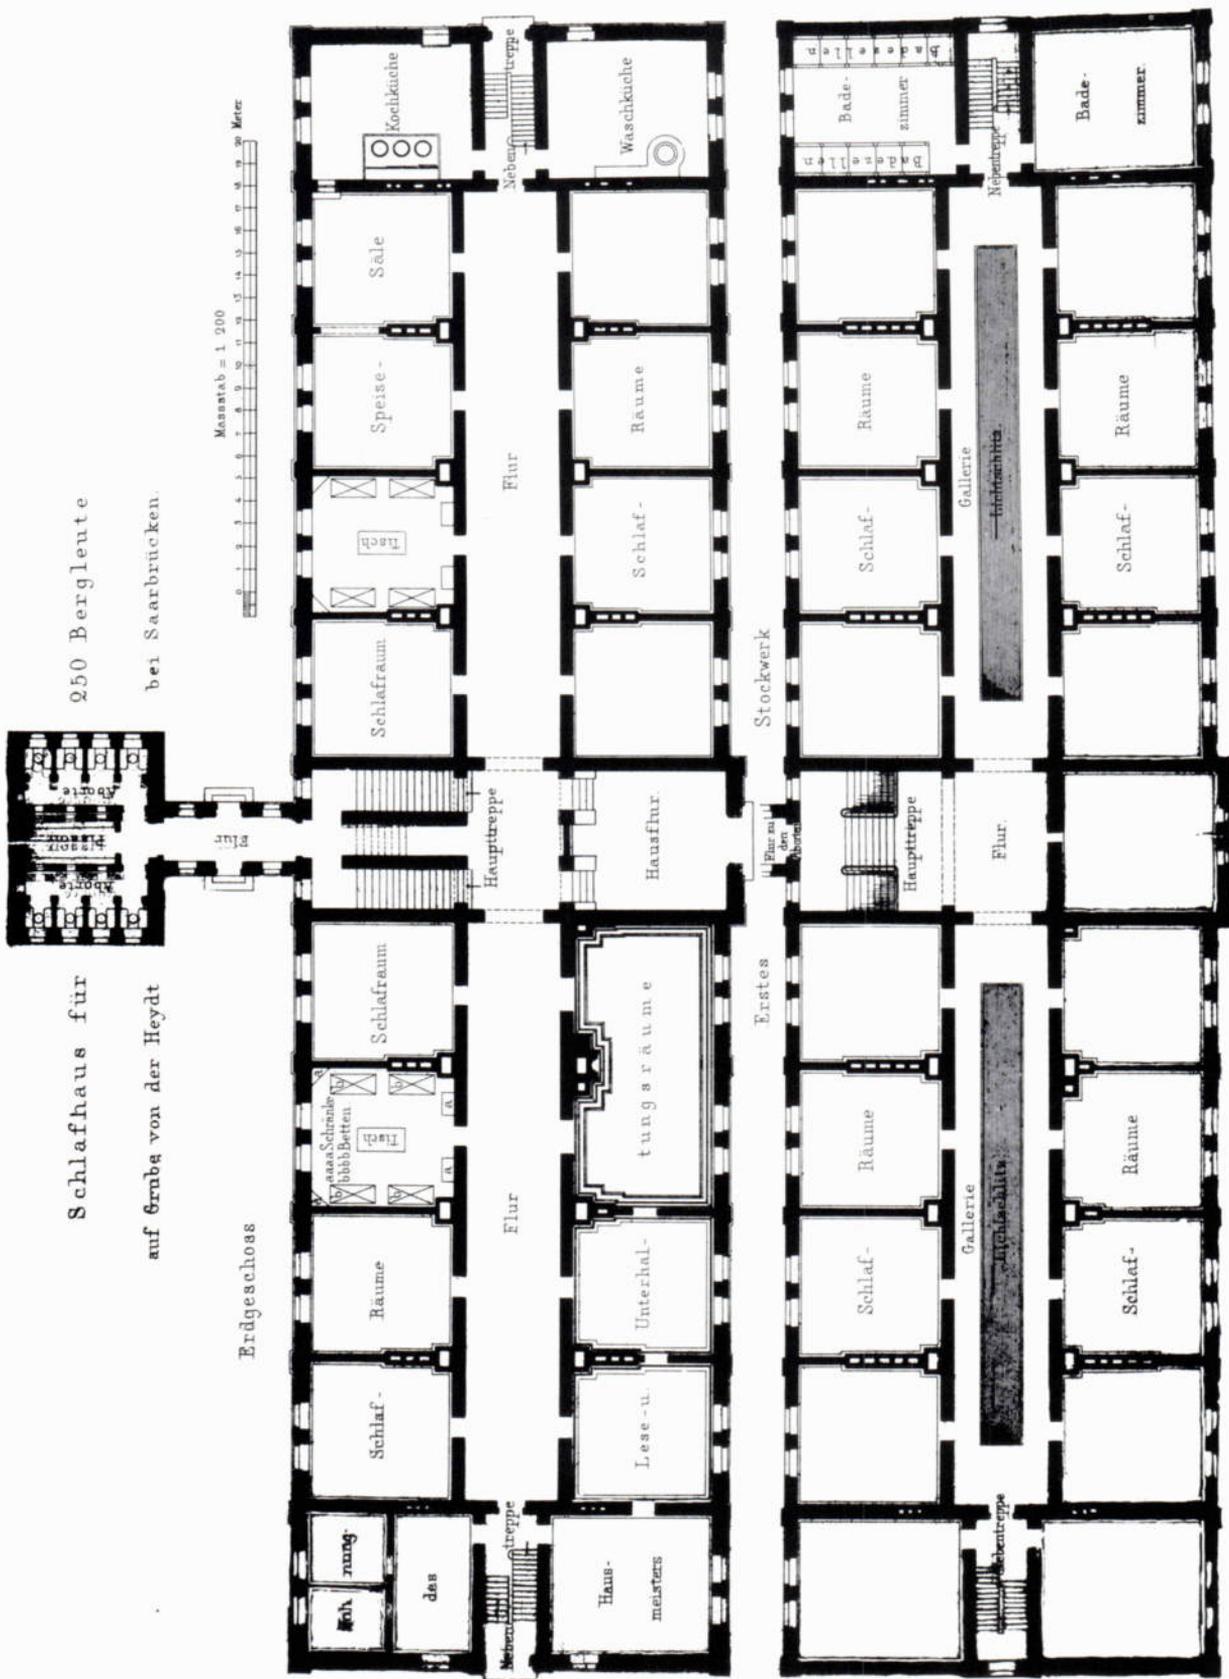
Plandokumentation des unteren Schlafhaus- und Kasinogebäudes, Grundrisse, Erdgeschoß und Obergeschoß, 1876, Faksimile
